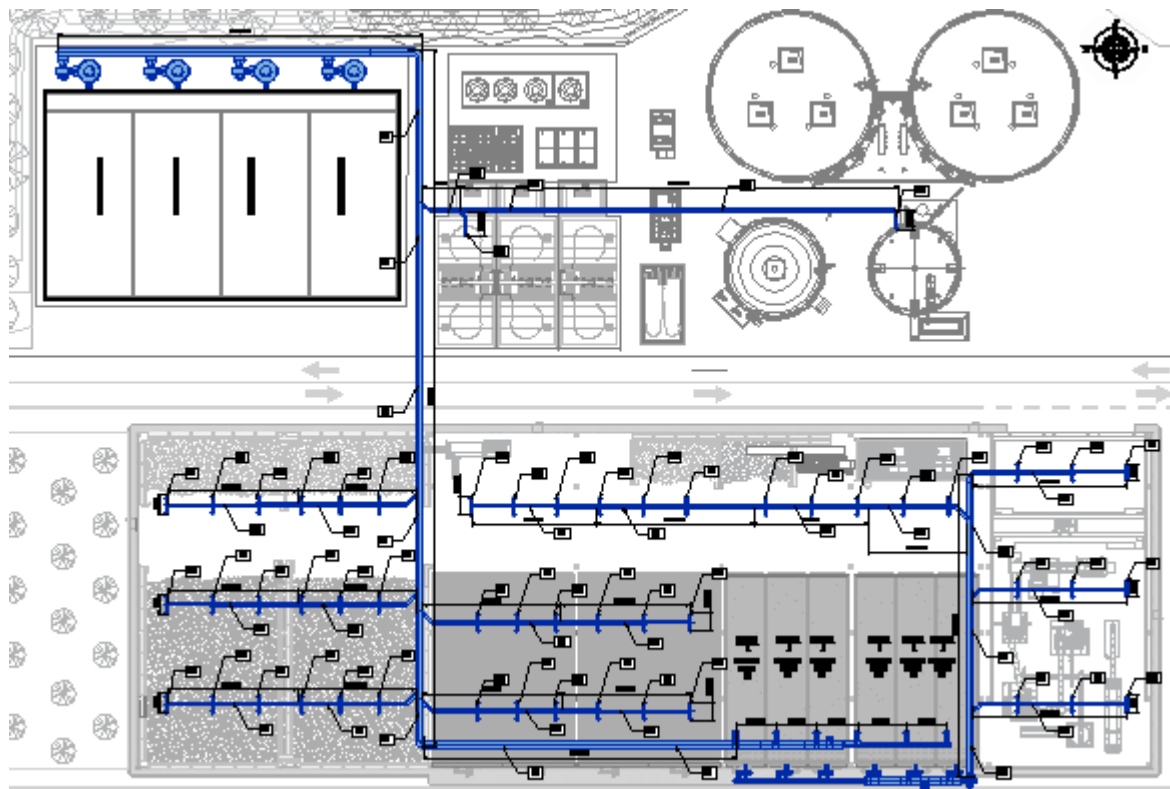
Planimetria rete aspirazione e ricircolo aria
